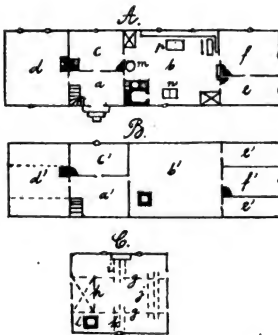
Grundrisse eines österbottischen Hauses. Ilmola. Wasa.
